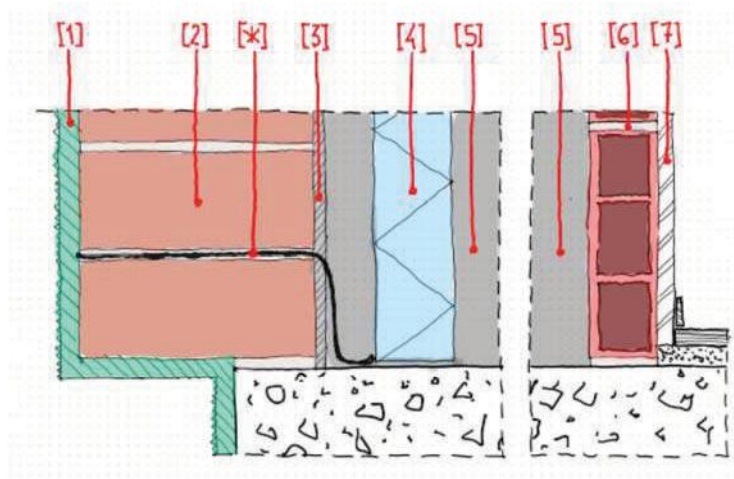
croquis de la sección vertical del cerramiento exterior construido.
